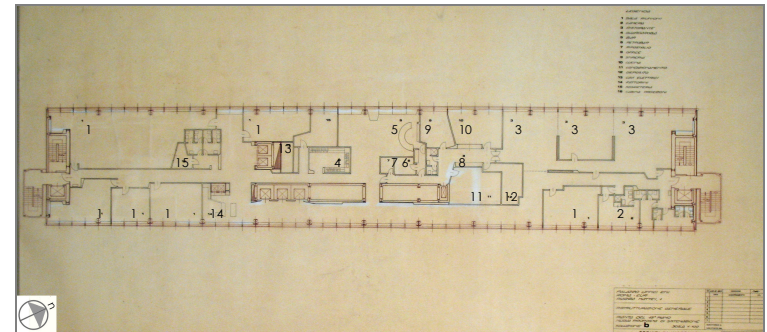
proposta di ristrutturazione generale – pianta piano 19° – soluzione b (fonte CSAC , stralcio tav. 76, archivio n. 70-1, rielaborazione f.m.)
